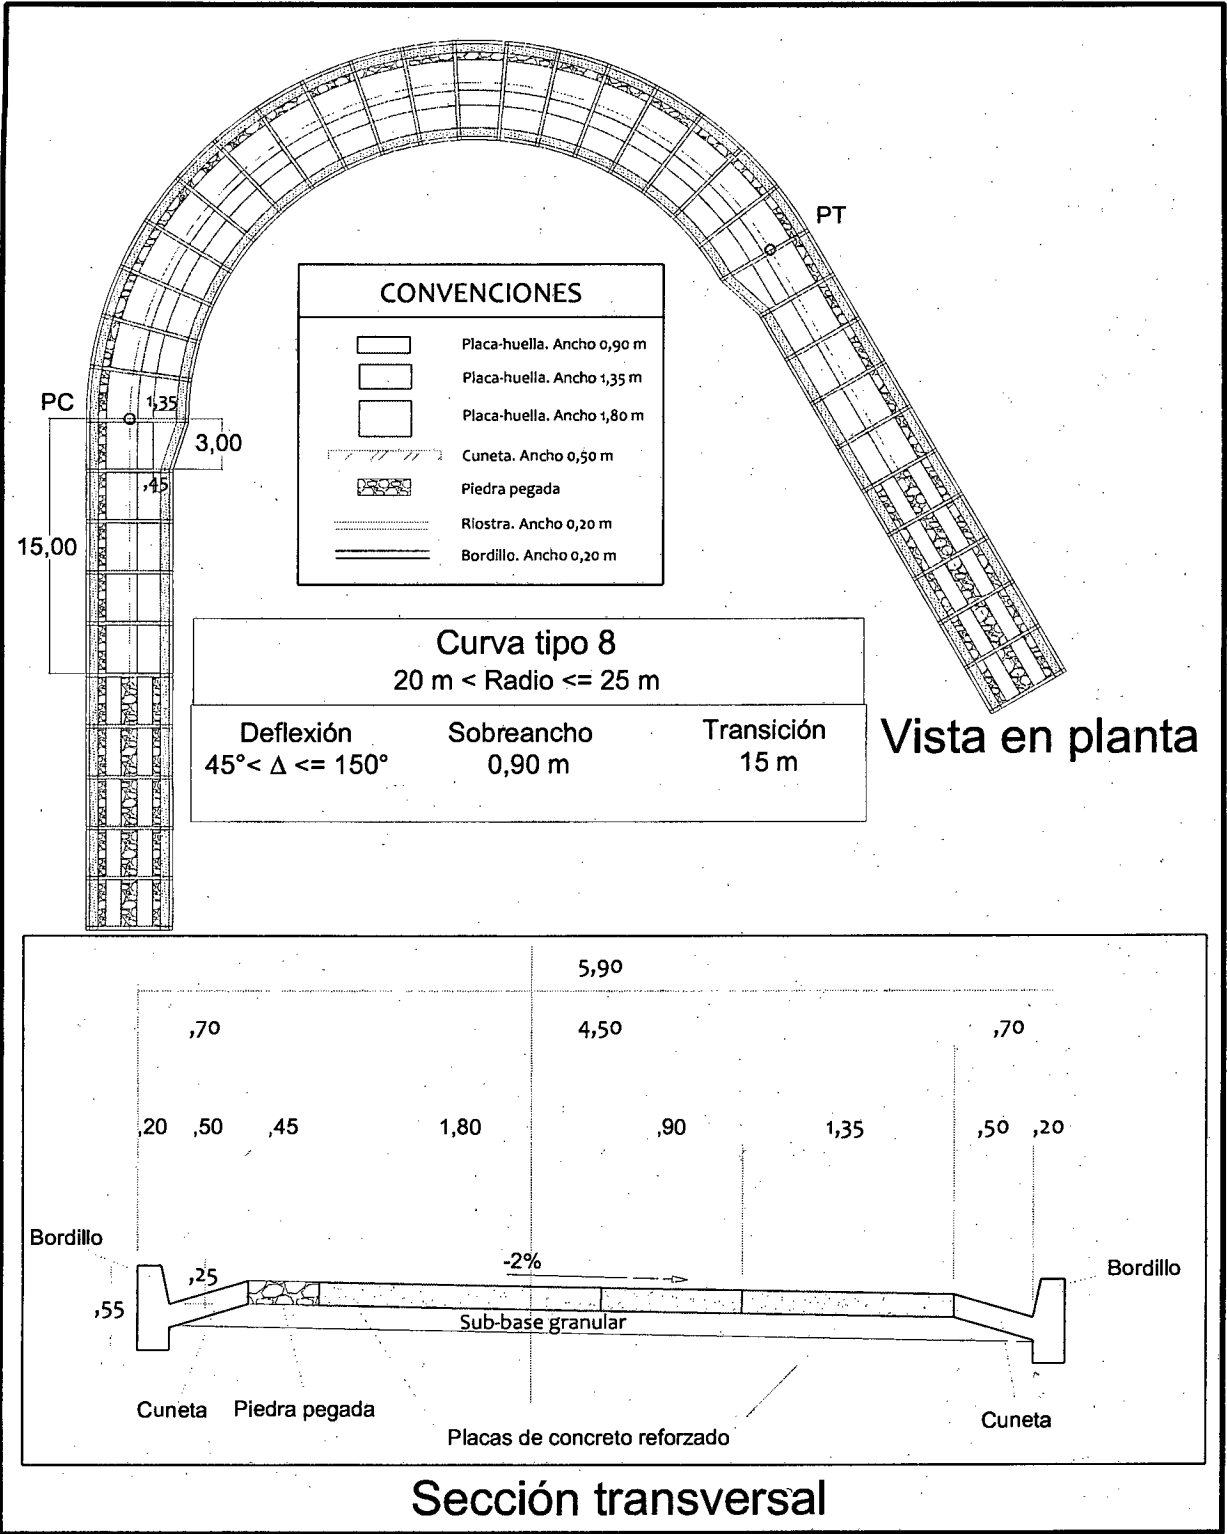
Vista en planta y perfil de la sección transversal en curvas TIPO 8 45 < Δ ≤ 150° y 20 m < Rc ≤ 25 m
